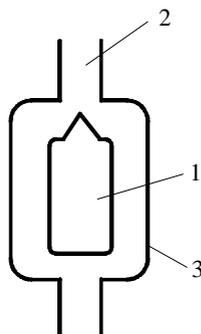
Принципиальная схема автоматического воздухоотводчика поплавкового типа: 1- поплавок; 2 – отверстие для выпуска воздуха; 3 – корпус
